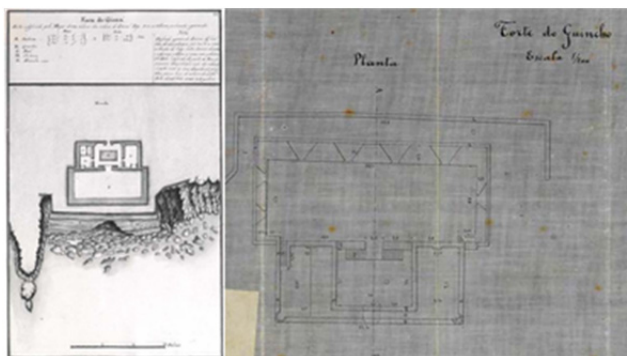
Plantas do forte do Guincho. Planta de geometria em “T” invertido. (IGEAEM 8124-3-43, 1796 e GEAEM 9020-5-66-85, 1892)
